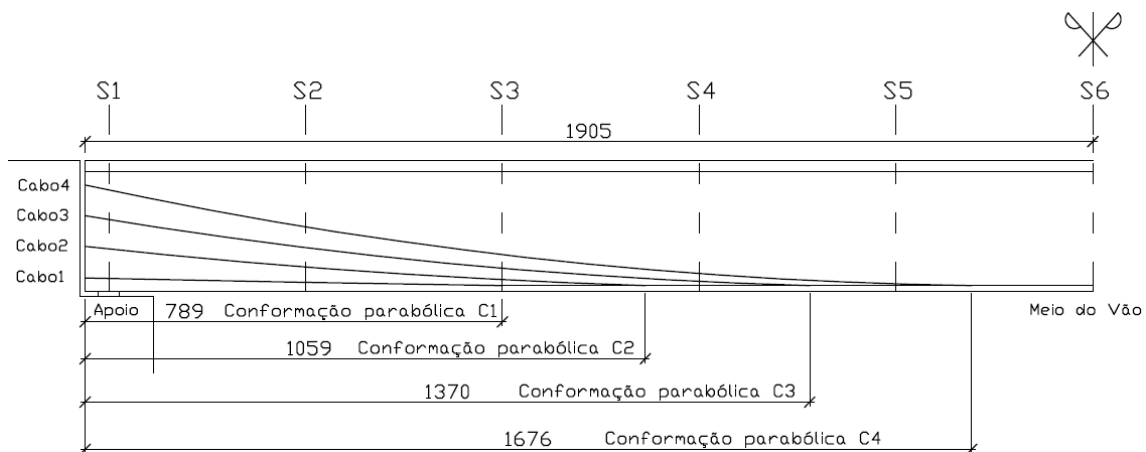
Traçado longitudinal dos cabos em elevação
